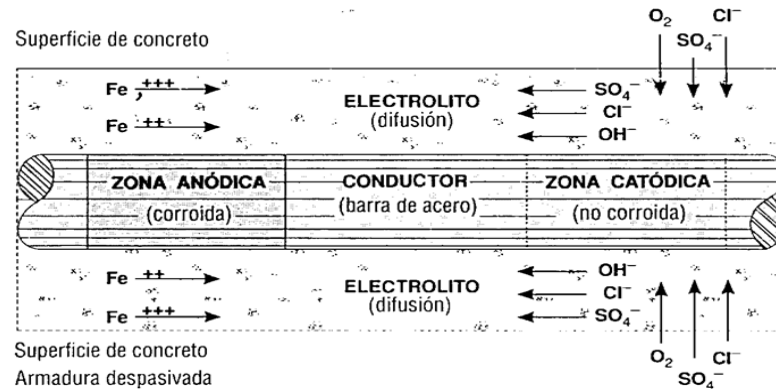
Corrosión en el concreto armado (Fuente Dr. Paulo r. Do Laho Helene)
